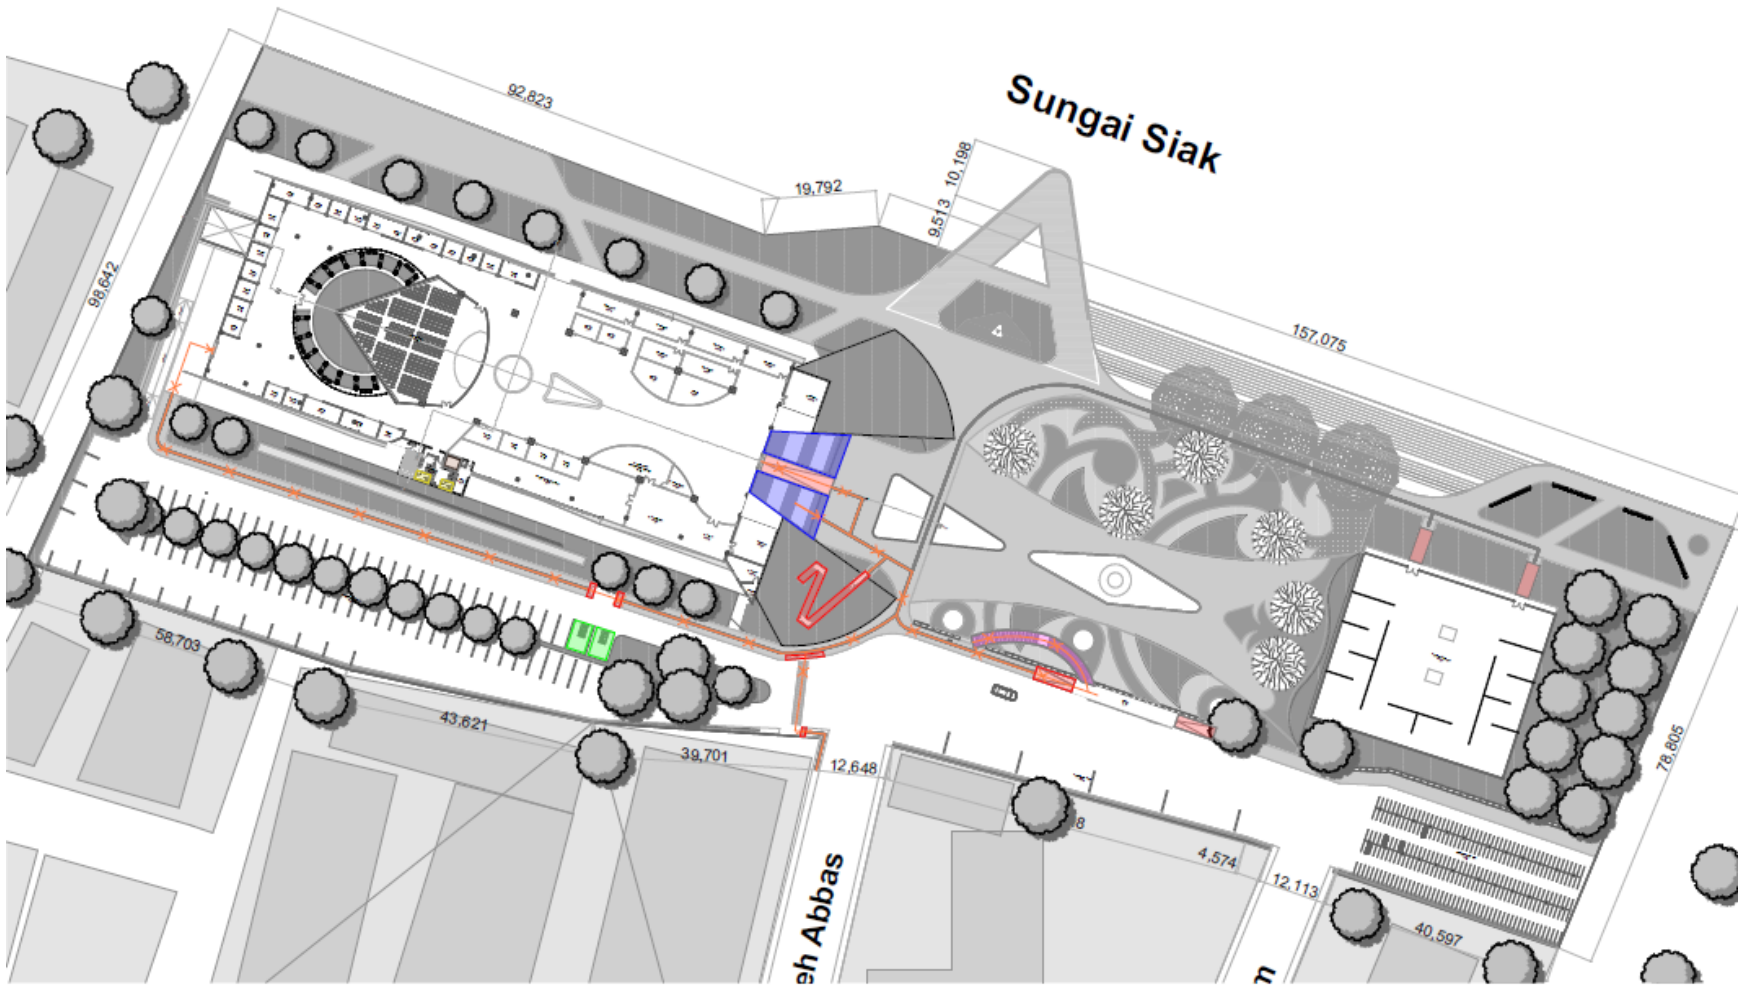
Rencana Penghawaan Buatan Lantai Groundfloor
